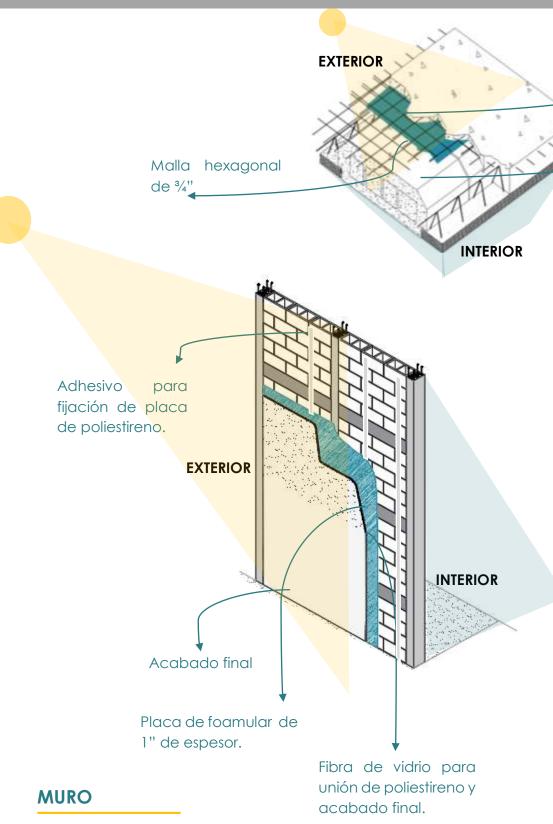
Sistema para confort climático en muros. Fuente: Elaboración propia. (2020).
